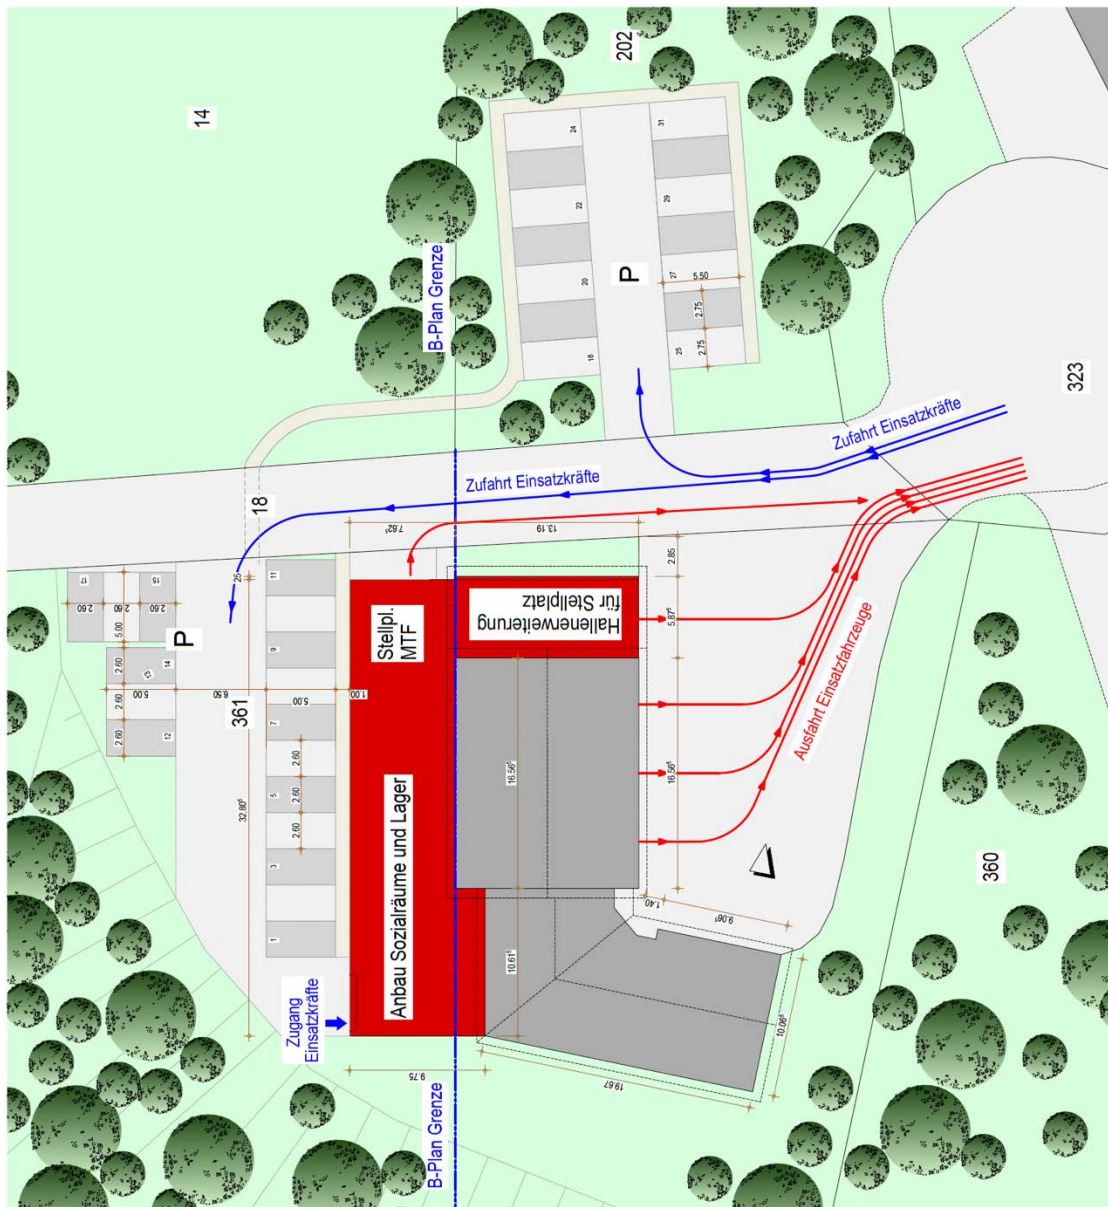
Lage- und Organisationsplan für den Anbau des Feuerwehrhauses (Quelle: Schneider Architekten)
